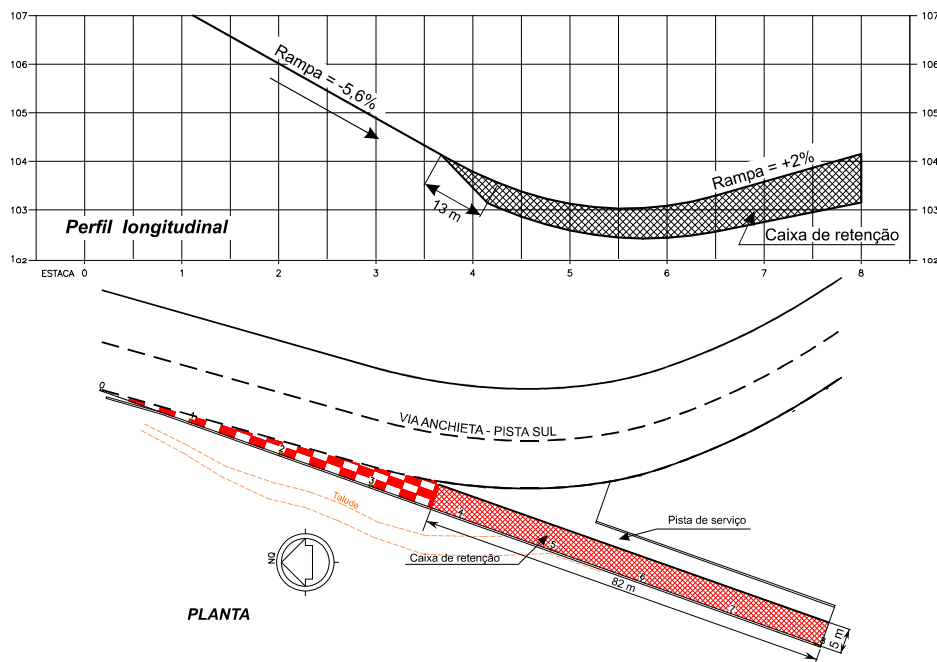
Perfil longitudinal e planta da área de escape do km 42 da Pista Sul da Via Anchieta
